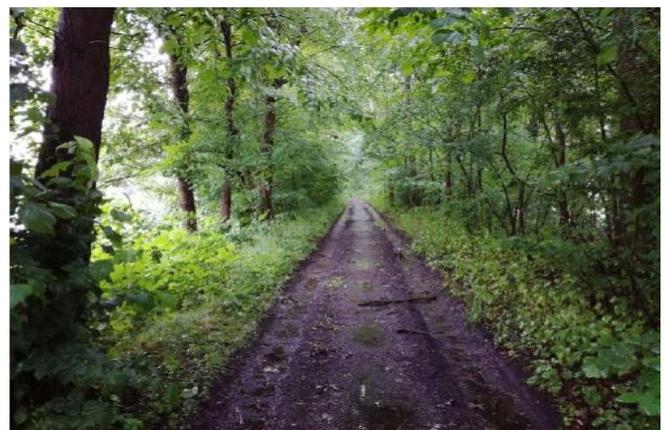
Damm mit Wegeführung und Laubbäumen und Sträuchern
